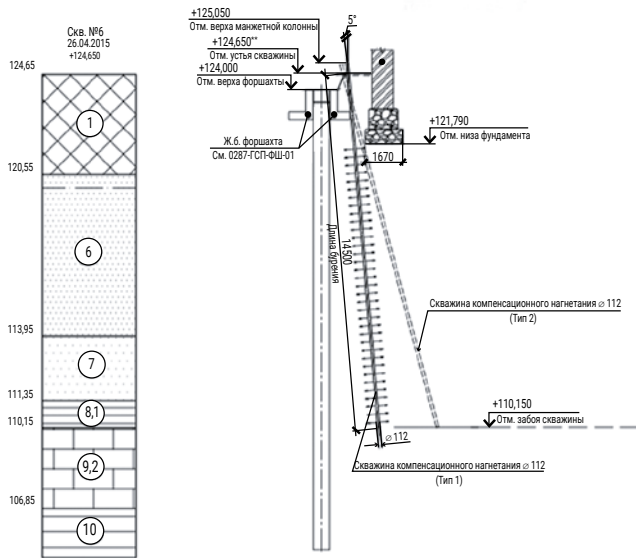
Схема выполнения работ по усилению грунтового основания фундаментов существующих зданий
